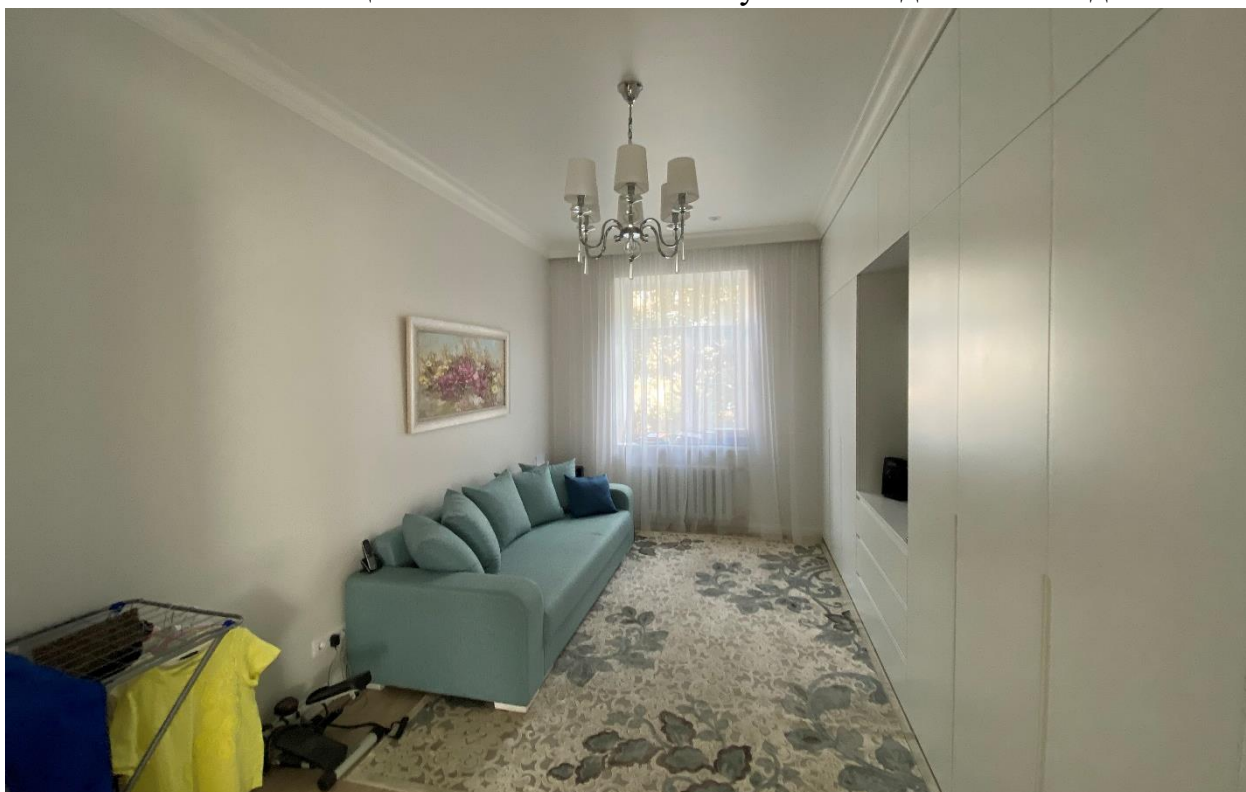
Помещение № 2 согласно плану ПИБ. Вид с юго-запада
